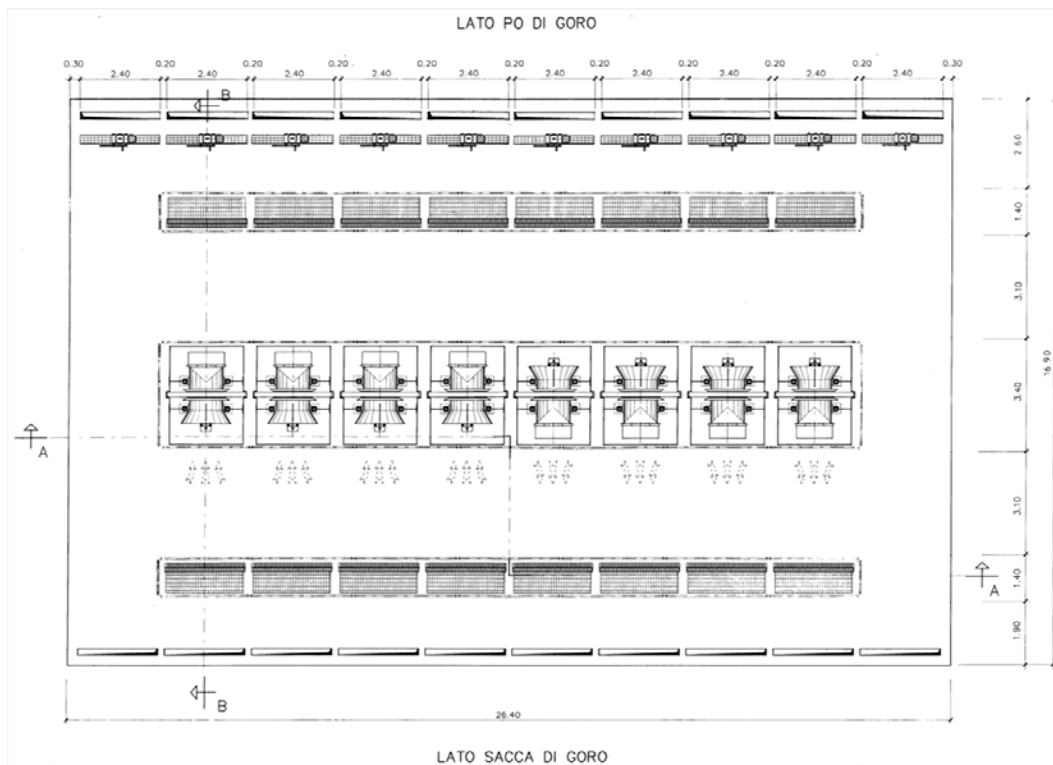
Planimetria dell'impianto idrovero Lanterna Vecchia
